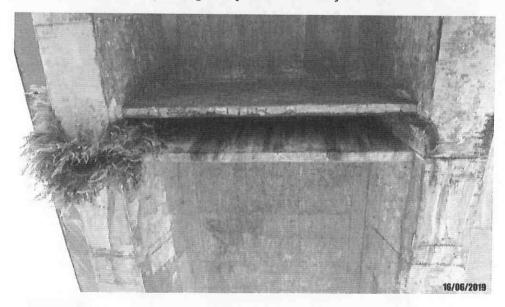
Detalhe da face inferior do tabuleiro com armadura exposta e vegetação nascendo dentro da junta de dilatação.
